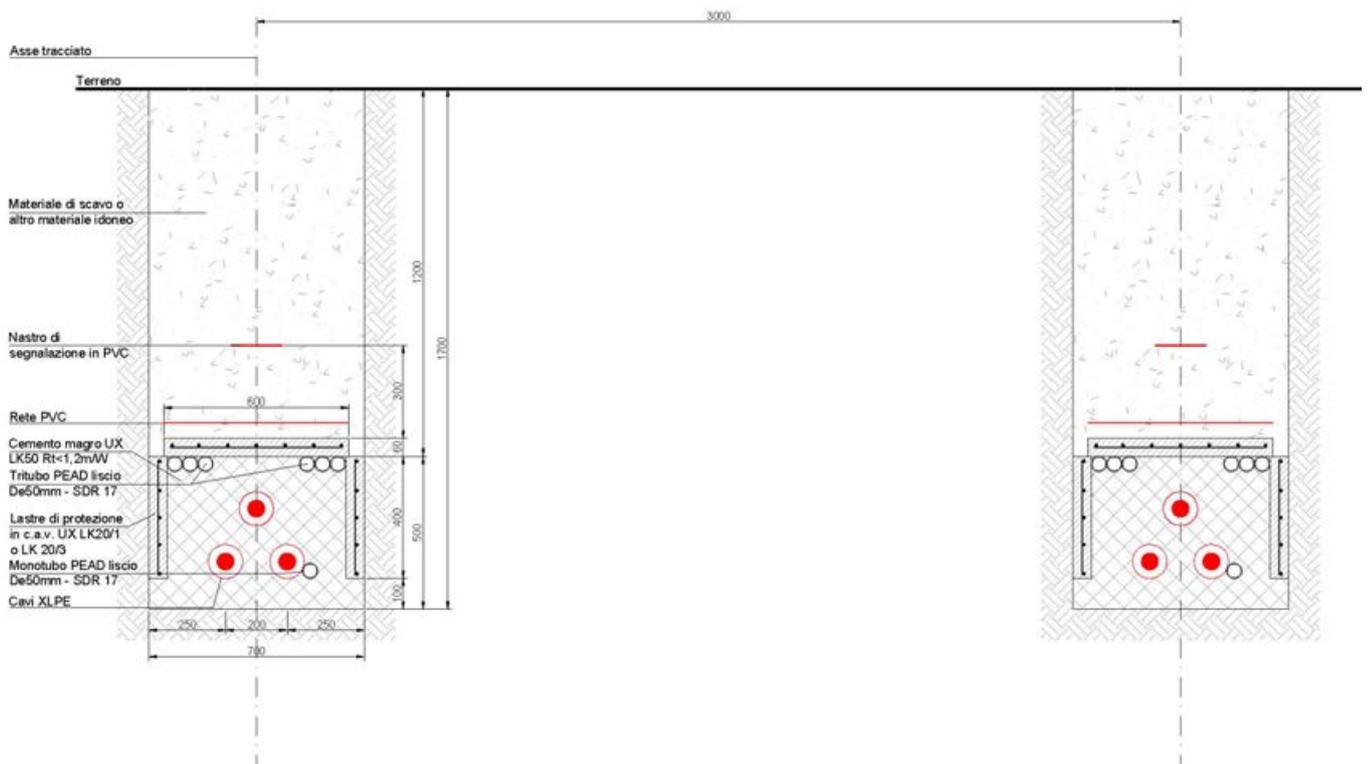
Sezione tipo di posa doppia terna A2
